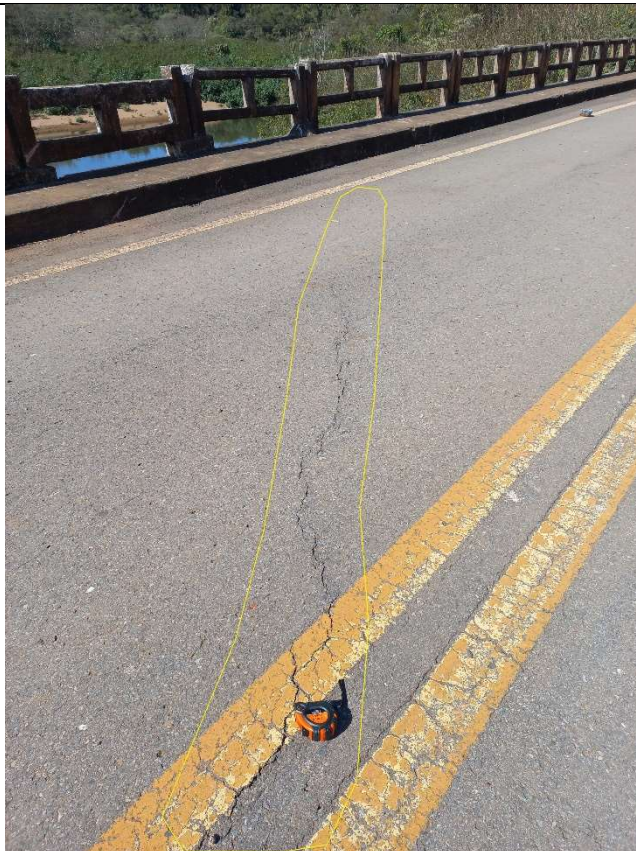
evidenciando fissuras e trincas no tabuleiro (26/07/2023)
